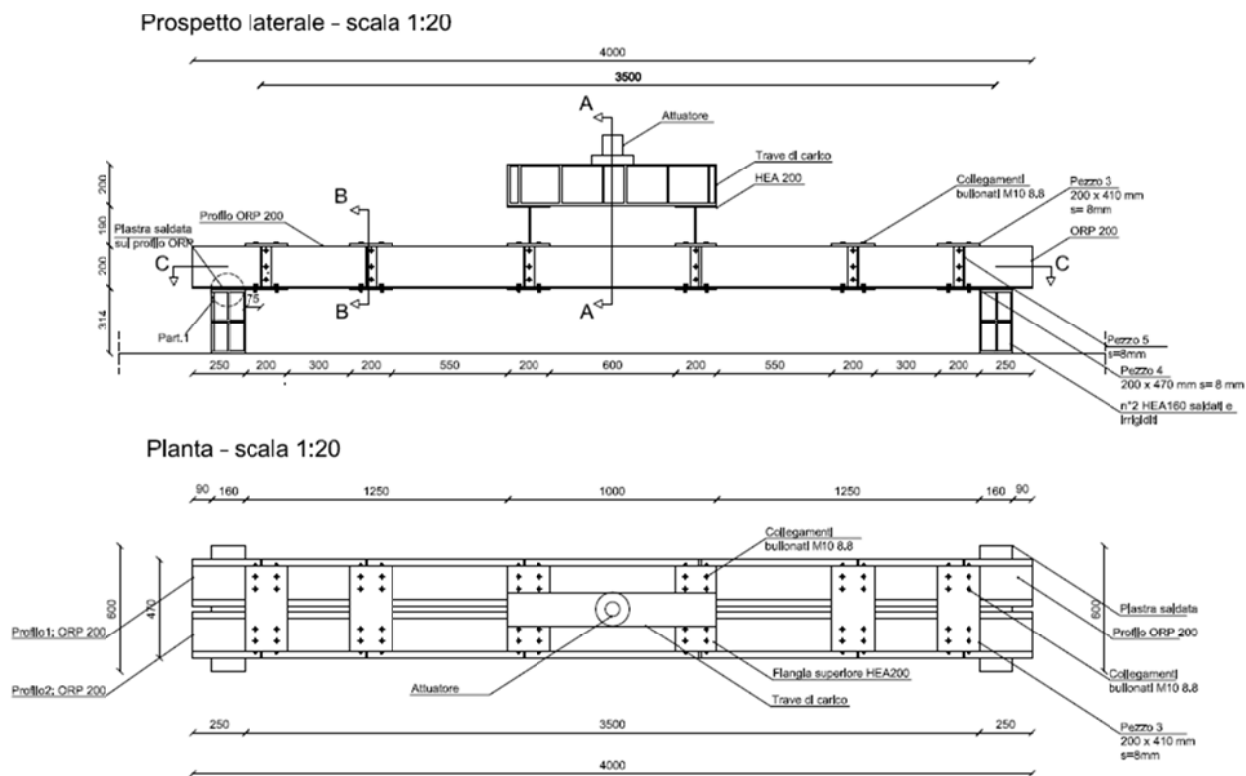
Stralcio elaborati di progetto: piante e prospetti.
